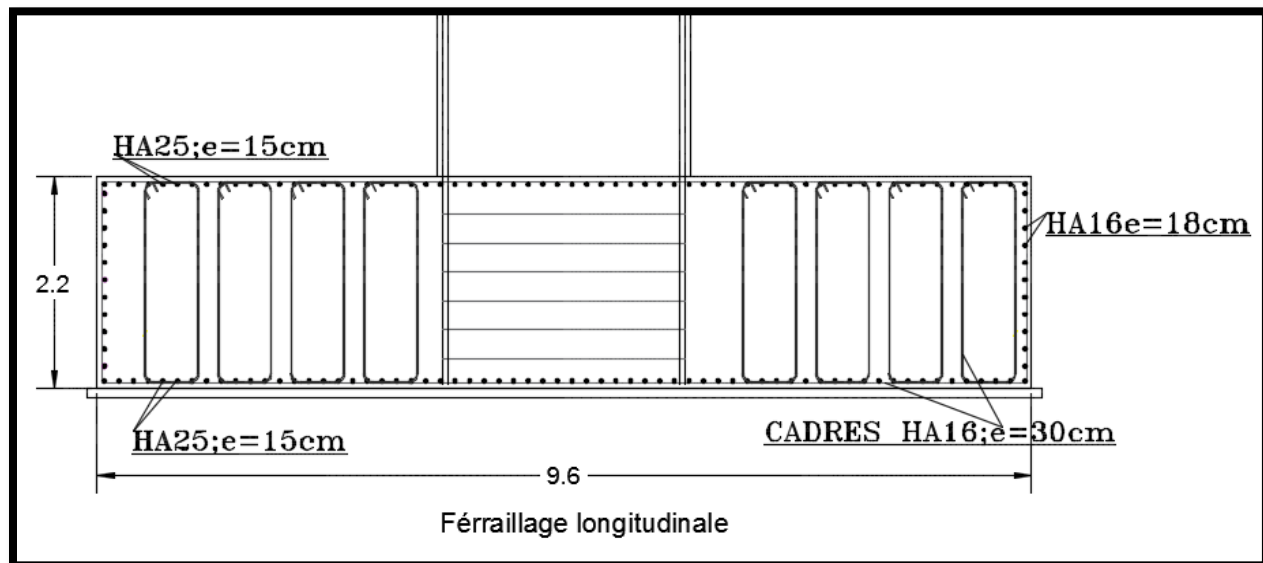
Schéma de ferrailage longitudinale de la semelle
